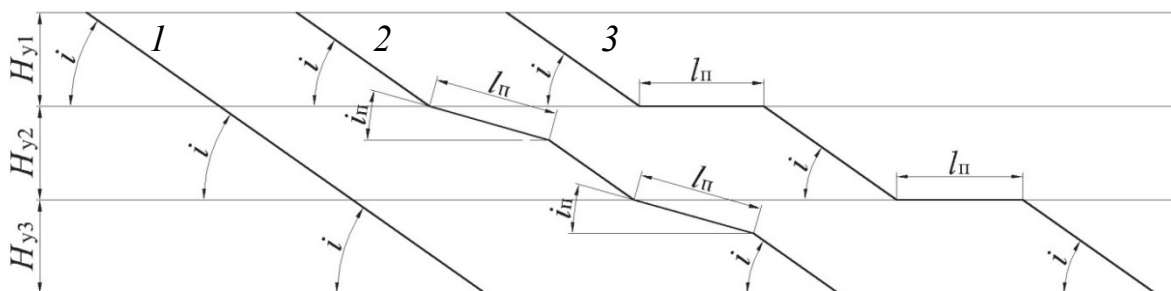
Схемы примыкания капитальных траншей к рабочим горизонтам:
